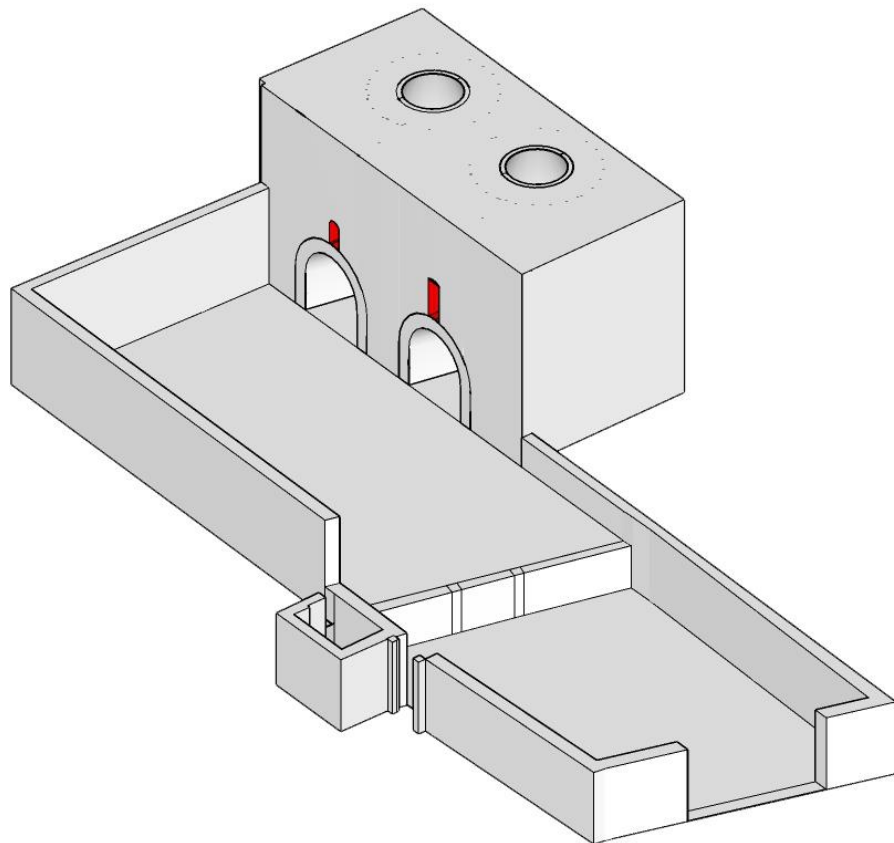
Restitution des deux fenêtres au niveau de la façade du four.
